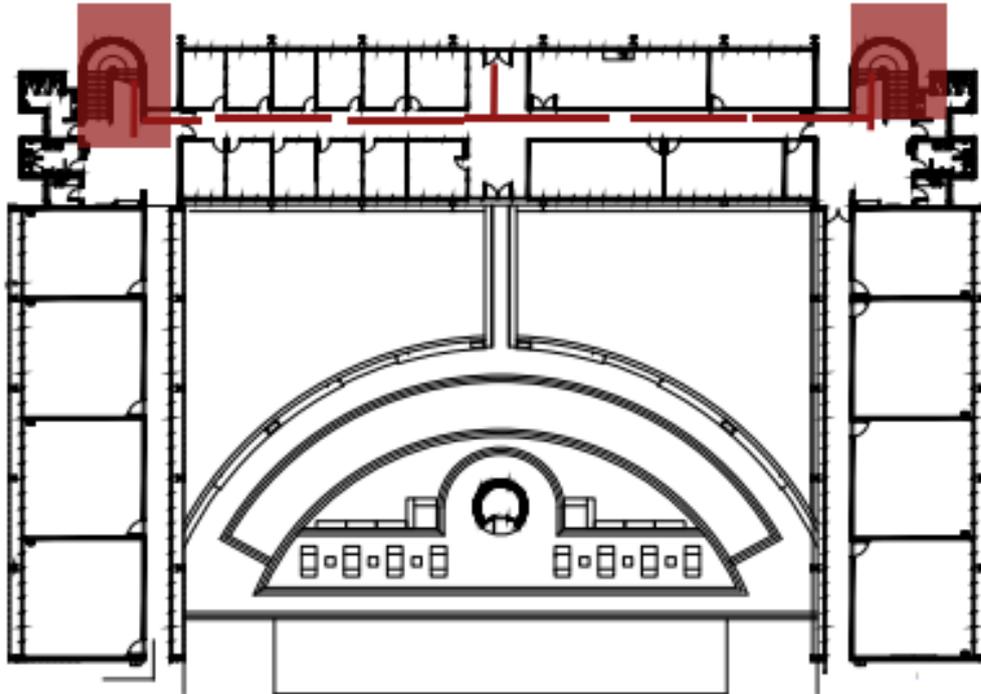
Planta da entrada secundaria ilustrando os acessos para segundo piso.
